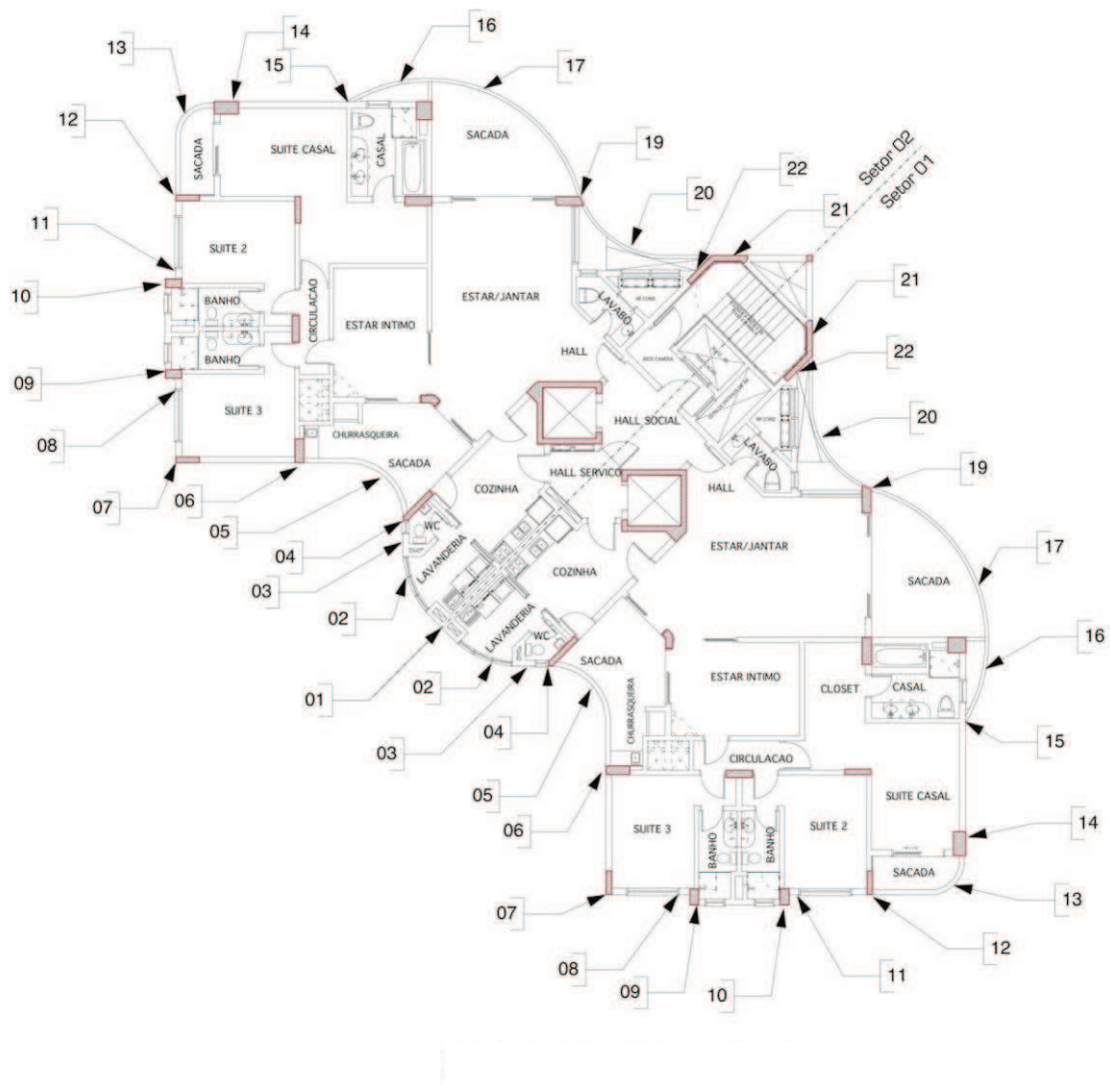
Planta Baixa do Pavimento Tipo com Pontos de Controle de conferência de prumo – sem escala.
